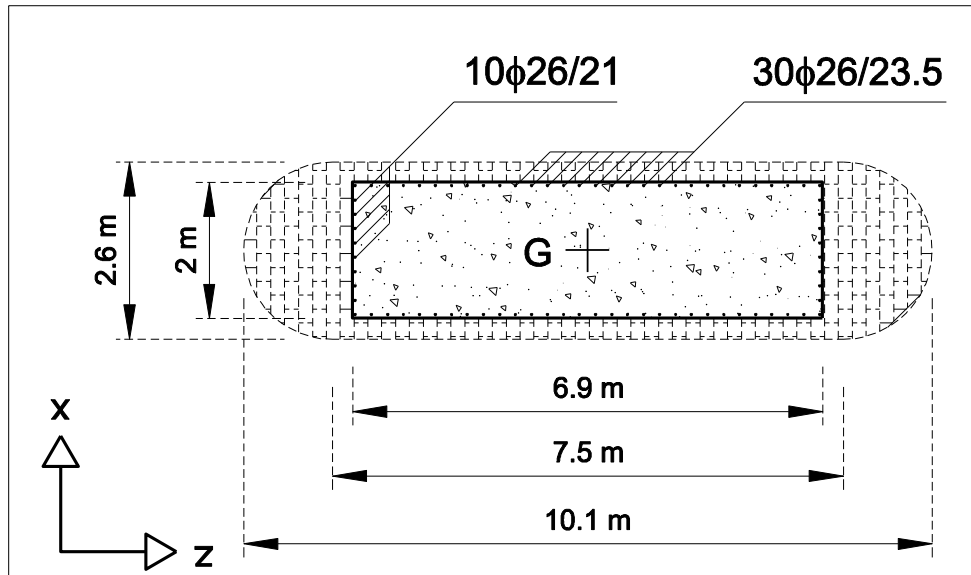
Sezione della pila di nuova costruzione: riempimento in calcestruzzo armato e distinta delle armature.
